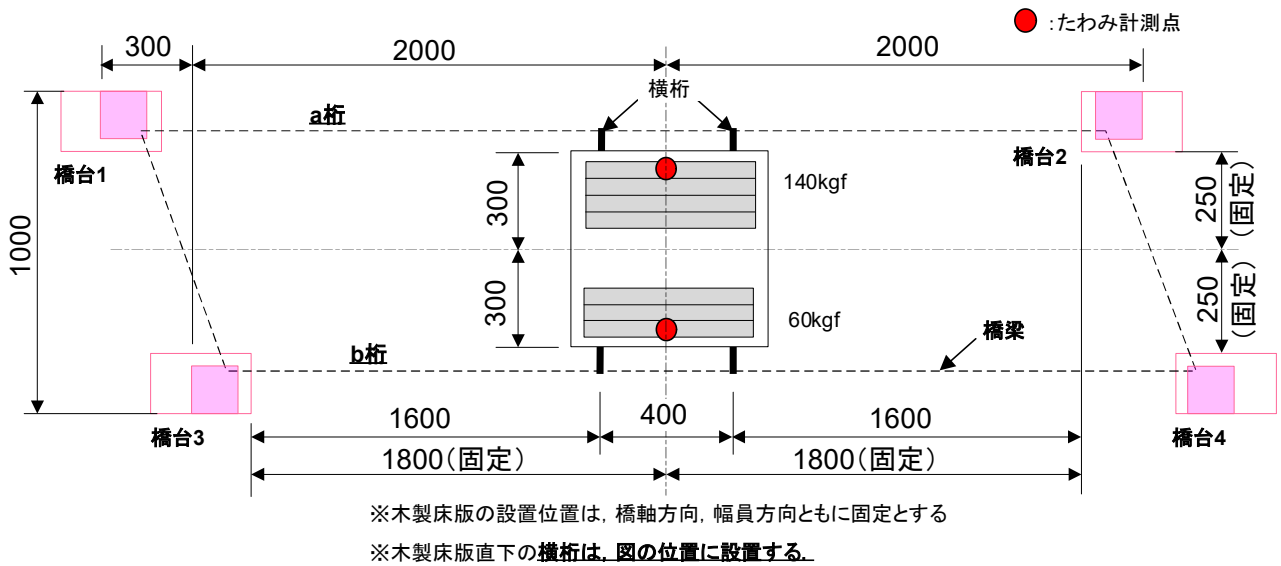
載荷場所とたわみ計測位置 (単位 : mm)
